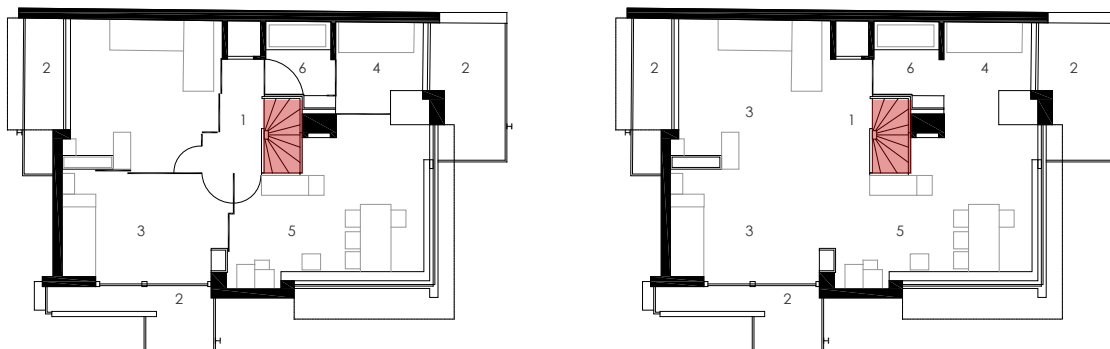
Planta Baja con núcleo de comunicación articulando la casa.
